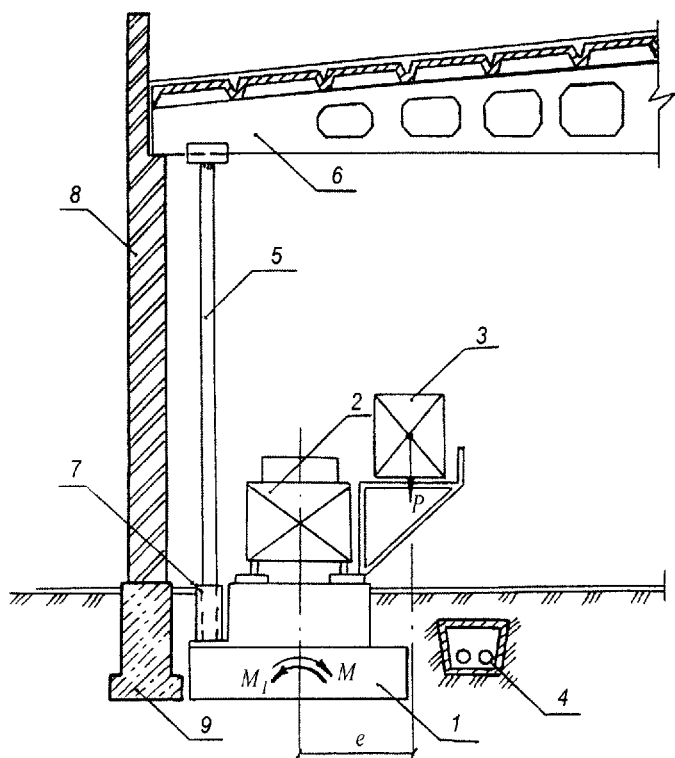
Схема усиления фундамента под оборудование, расположенное внутри здания: 1 – усиливаемый фундамент; 2 – эксплуатируемое тяжелое оборудование; 3 – груз, создающий временную дополнительную эксплуатационную нагрузку; 4 – эксплуатируемые подземные коммуникации; 5 – стойка из металлической трубы; 6 – несущая балка покрытия (упорная конструкция); 7 – отрезок металлической трубы с внутренним диаметром, превышающим диаметр стойки 5; 8 – наружная стена эксплуатируемого здания; 9 – фундамент стены эксплуатируемого здания
